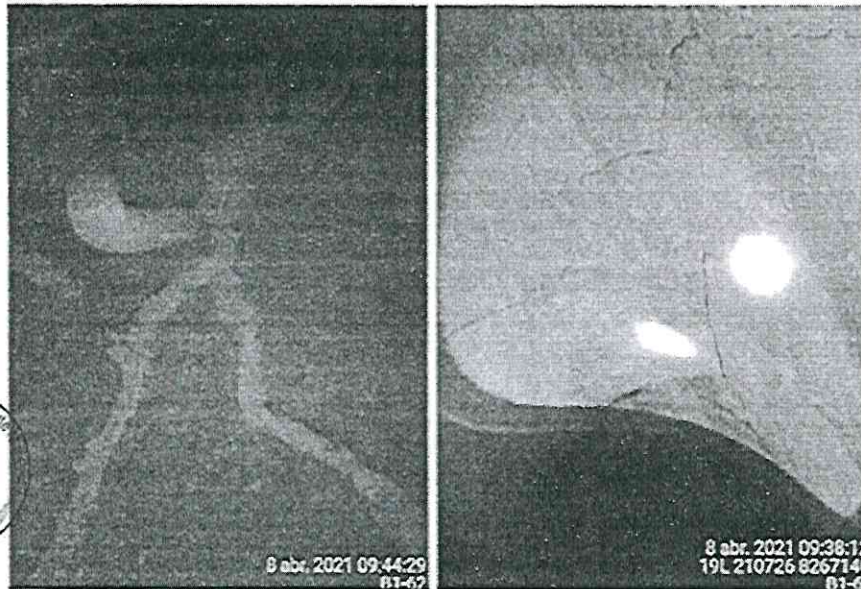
Grietas radiales y fisuras en la estructura del Túnel 9
